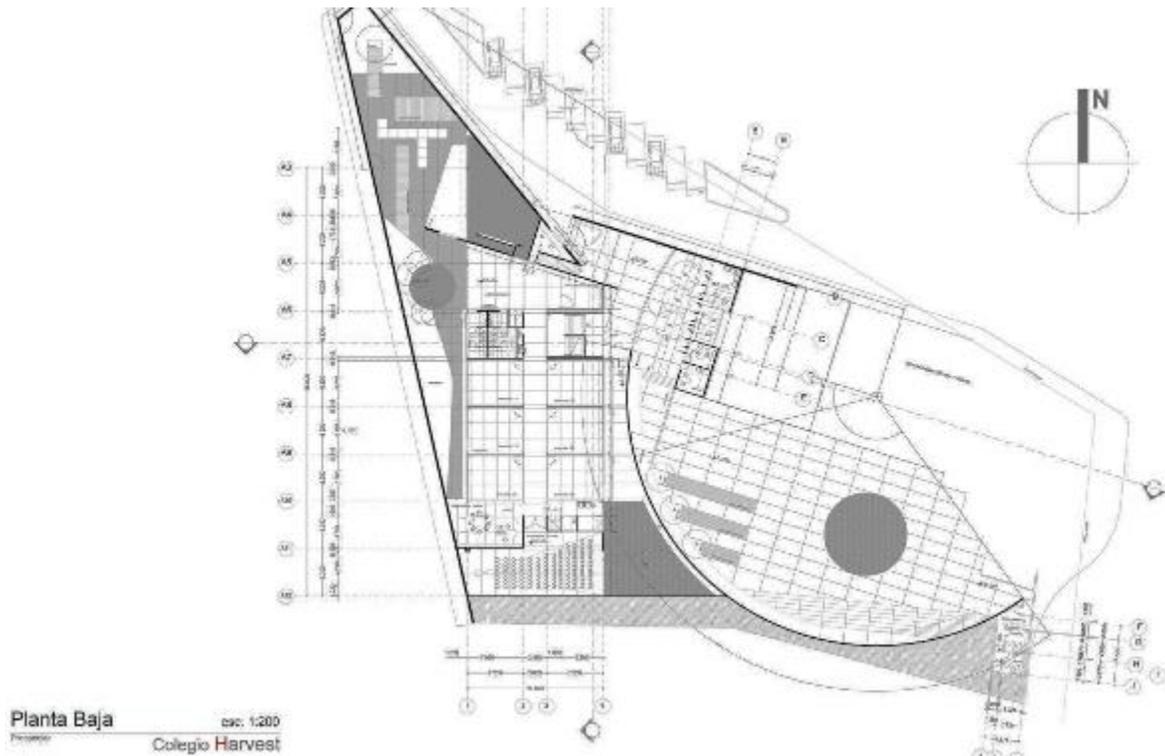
Planta de Primer Nivel, Fuente: <http://colegioharvest.edu.mx/>
